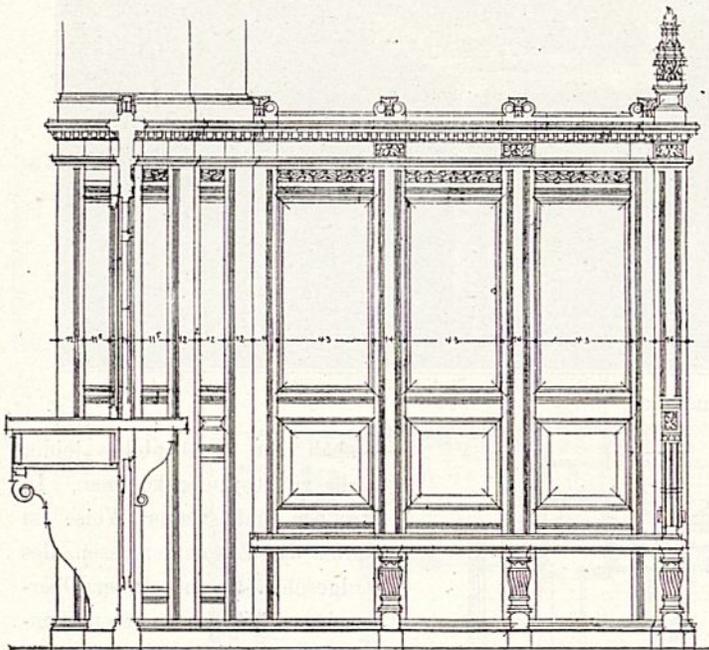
Schalterhalle im ersten Obergeschoß. Wand E (s. Abb. 3).
